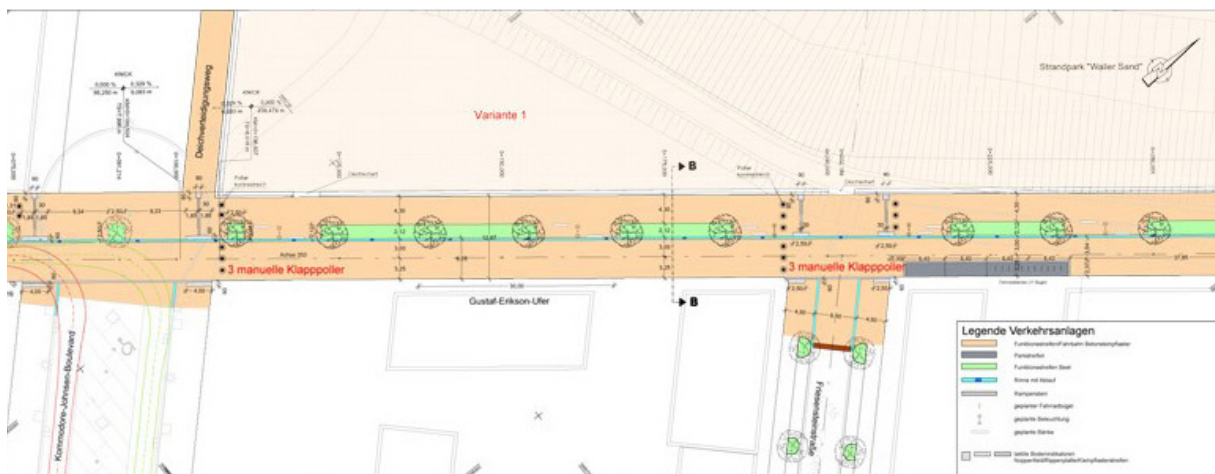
Verkehrsanlagen Gustav-Erikson-Ufer Lageplan Mai 2019
